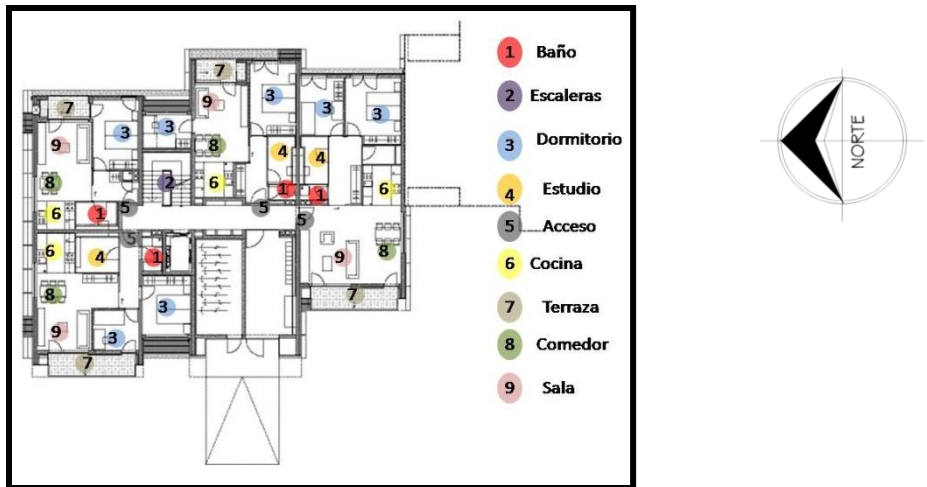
Planta tipo del nivel 1. Fuente: <http://www.arkinetia.com/Articulos/art100.aspx>. S/E.
